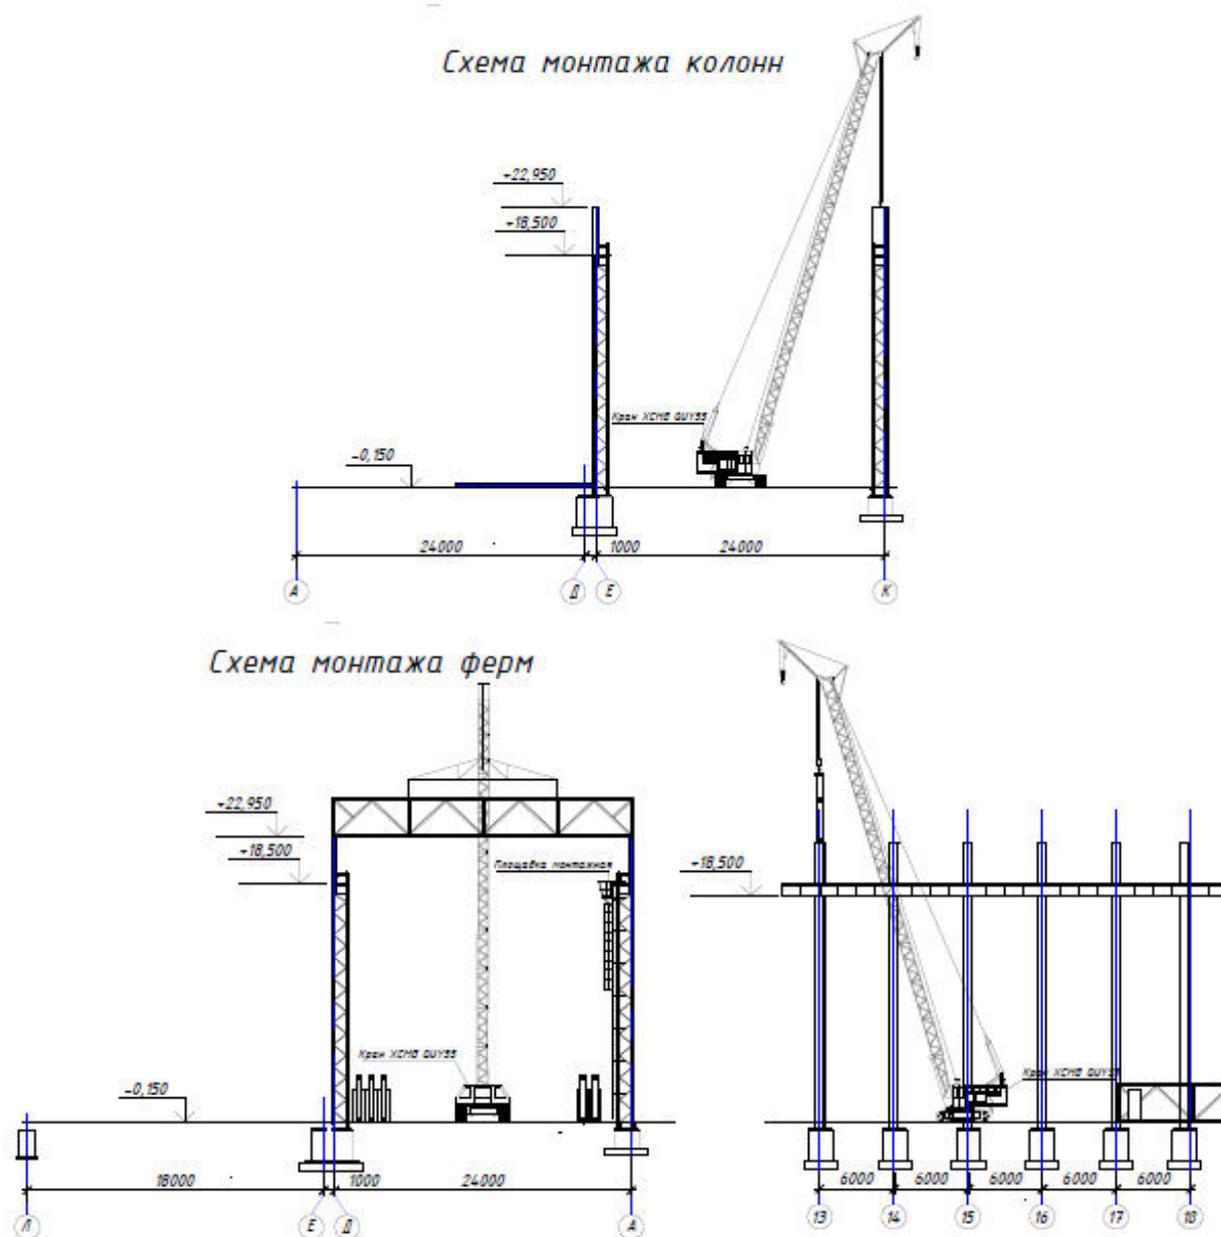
Схема монтажа колонн и стропильной фермы
